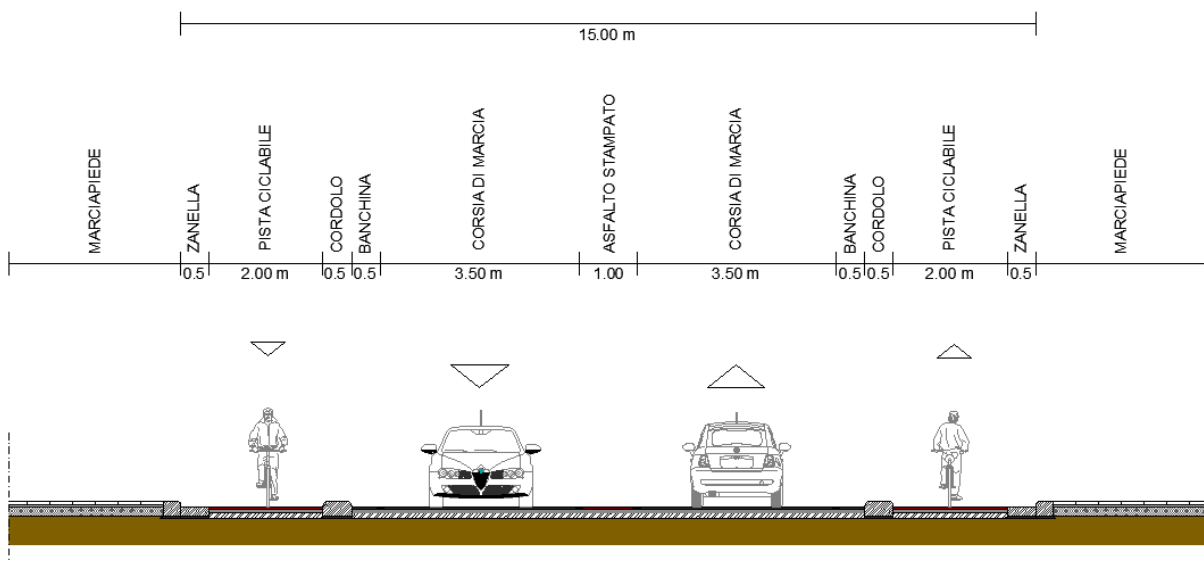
via Cassiodoro, sezione trasversale di progetto.
